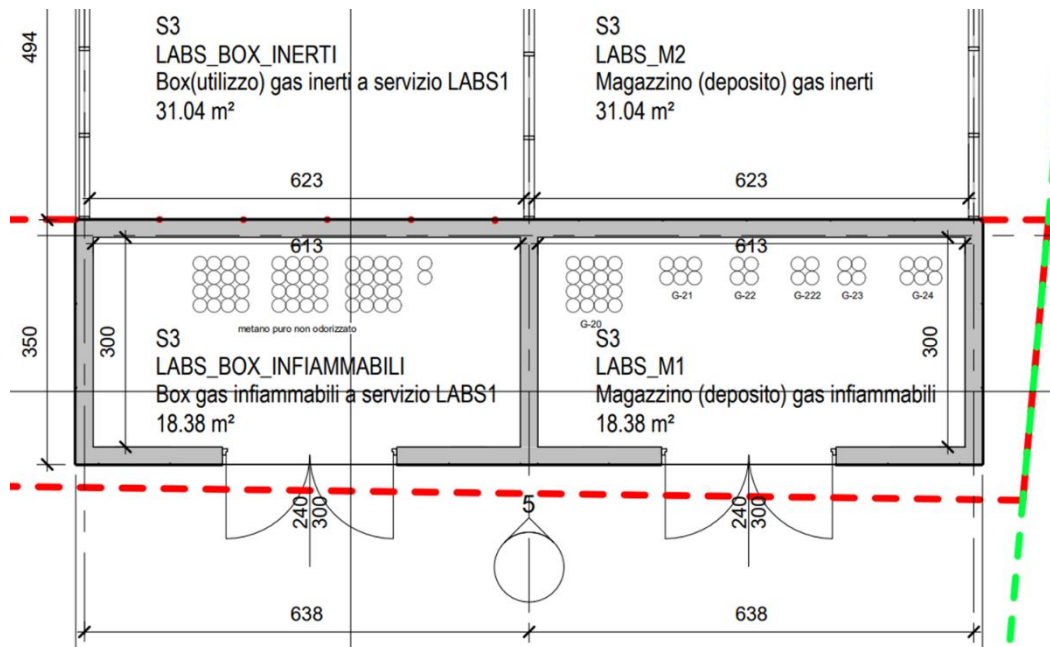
stralcio doc. P0027388-1-M3_2 (foglio 3) “Edificio S3 – pianta, prospetti, sezioni, layout fondazioni”.
